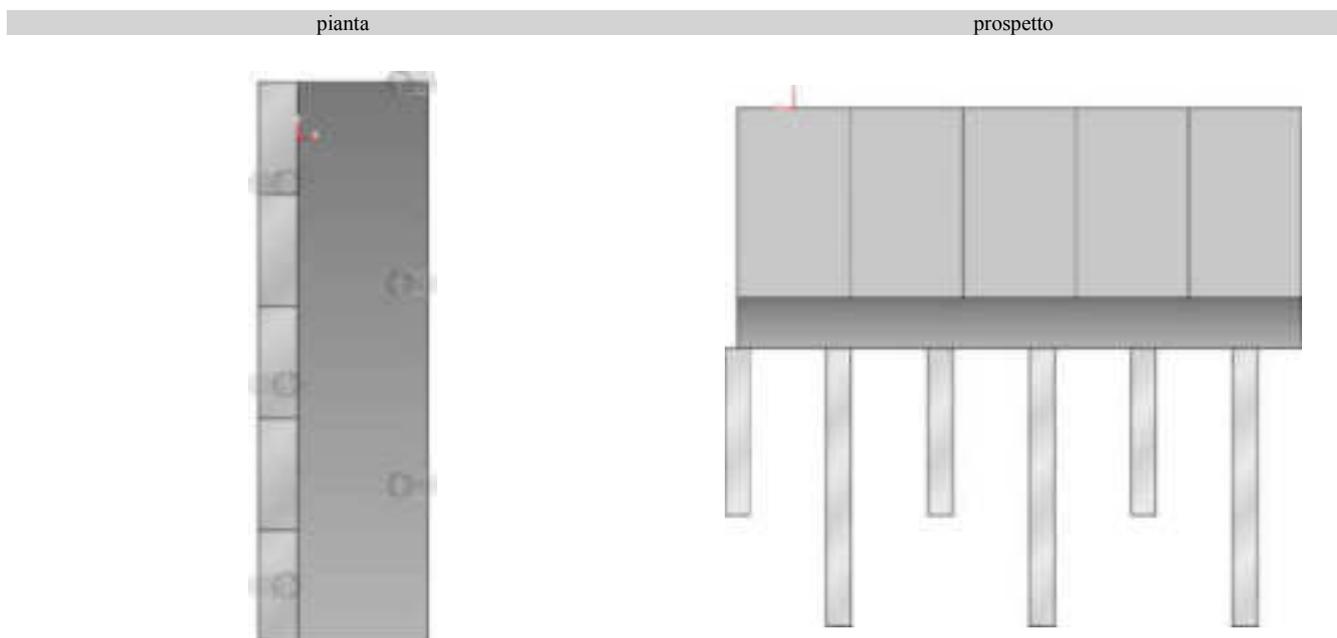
Pianta e Prospetto Modulo Tipo
